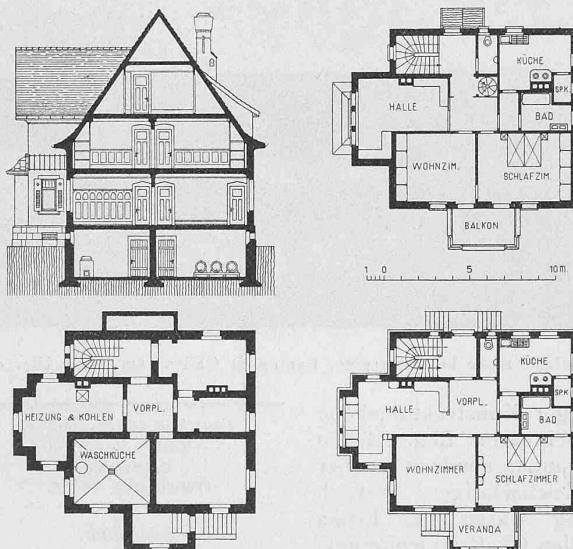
bis 4. Grundrisse und Schnitt 1:400 des Hauses Valär in Kilchberg bei Zürich.
